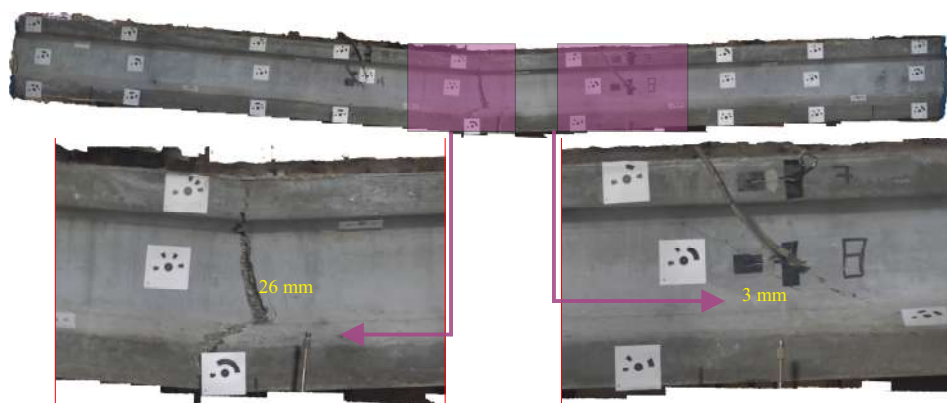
Fissuração máxima no 4<sup>o</sup> Ciclo - Viga UHPFRC protendida (V02)
